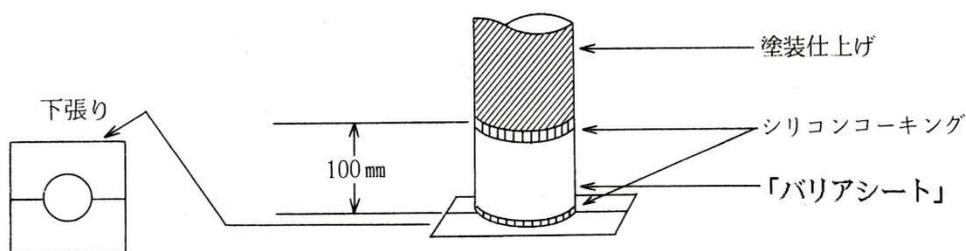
屋根板付属品（ルーフサポートガイド）の施工要領
